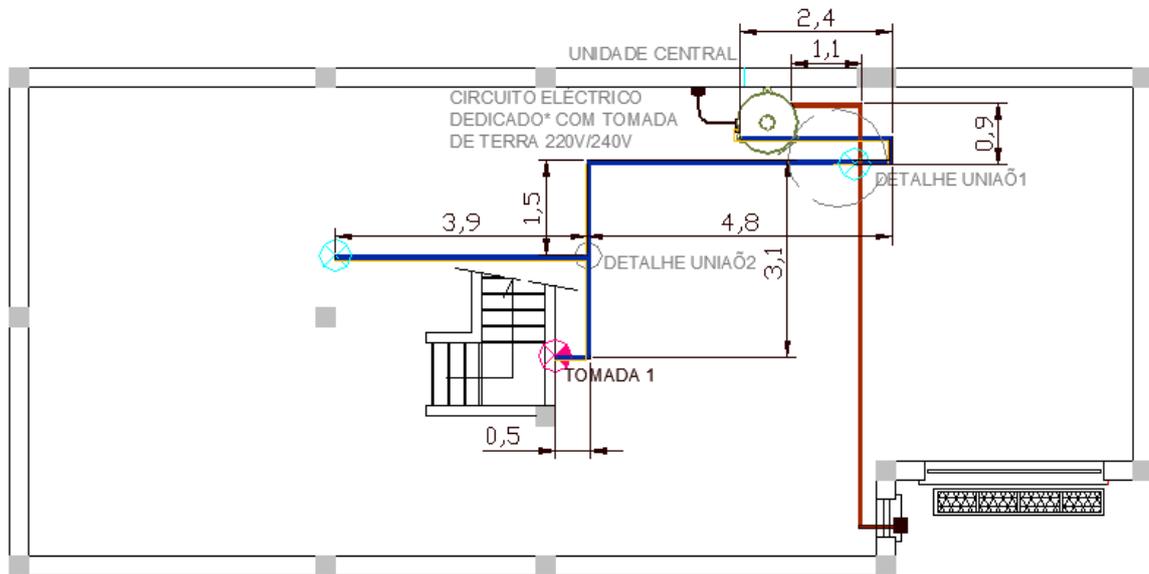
Cave – Solução B - Traçado e Dimensionamento em planta
